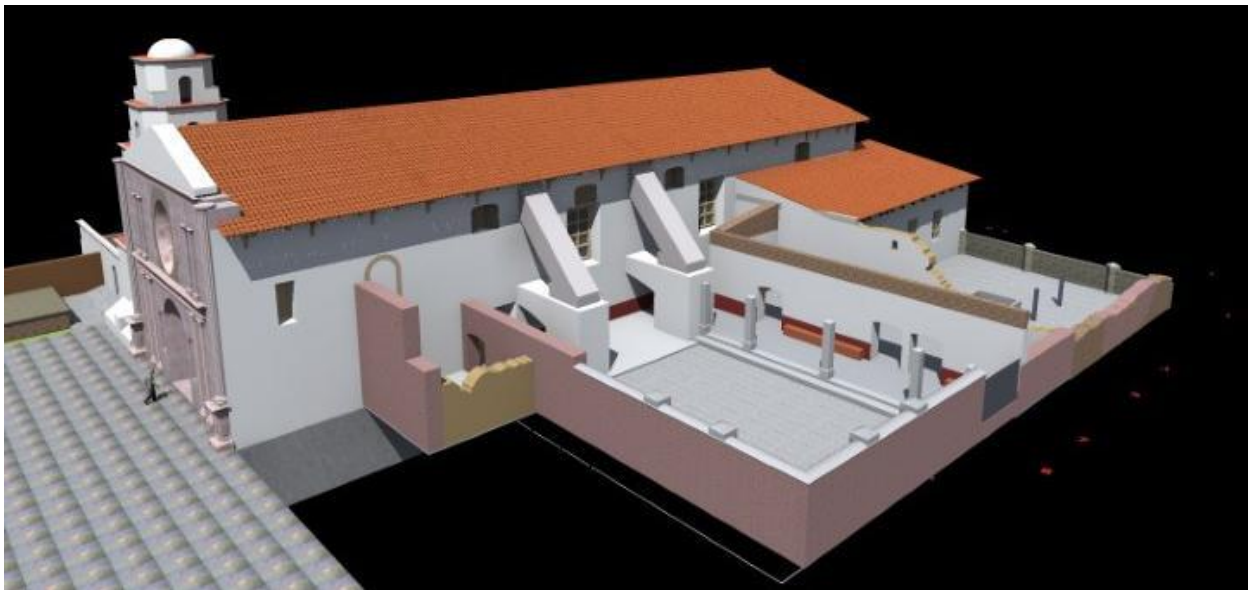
Perspectiva del conjunto. Fachada Sur
